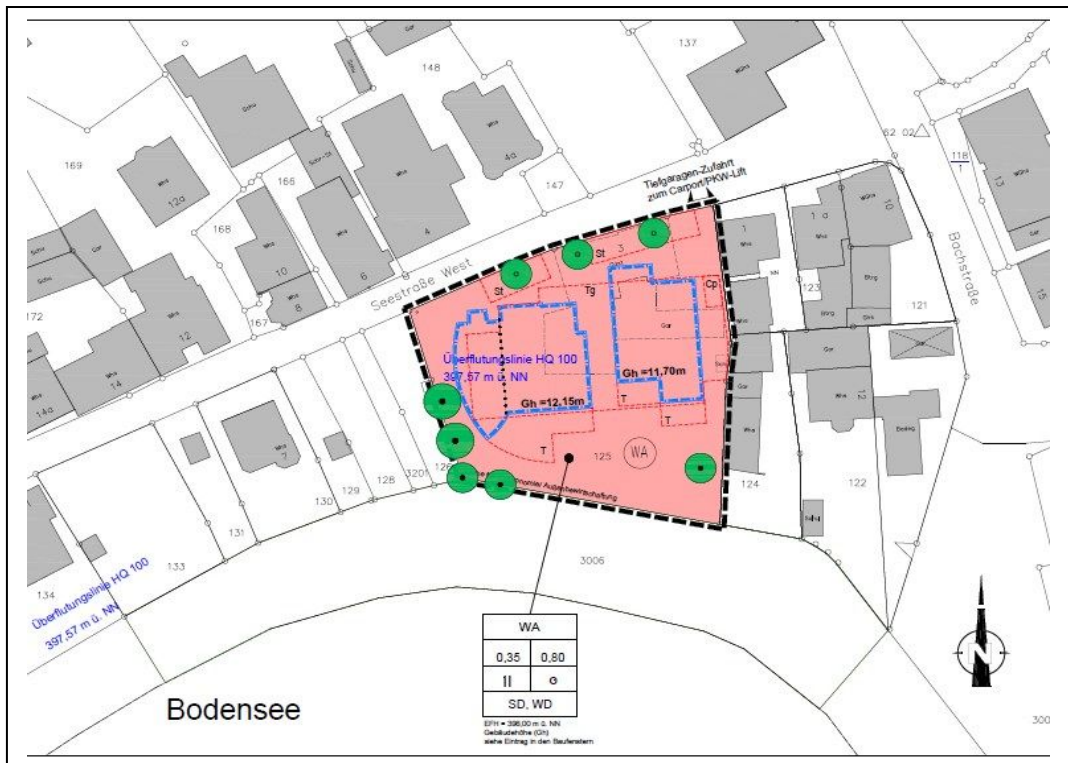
Lageplan mit Eintrag des Plangebietes in Immenstaad (HORNSTEIN in lit. 2020)
